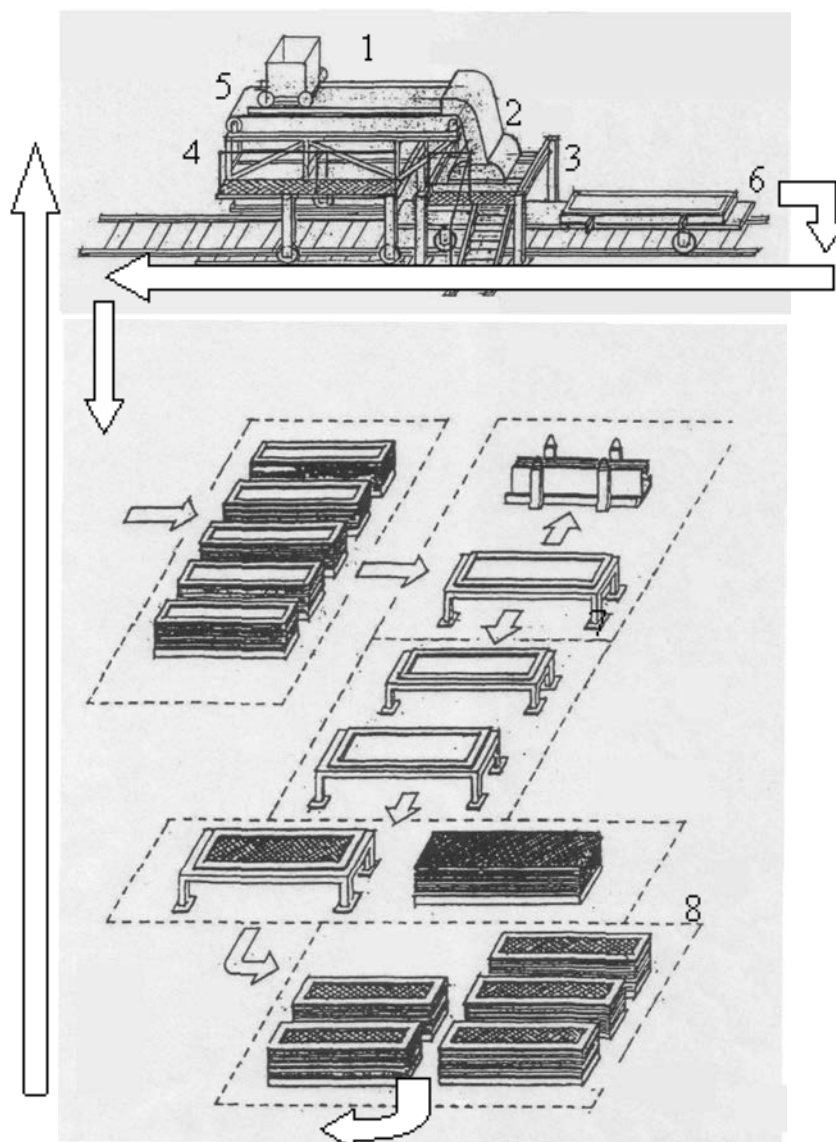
Схема производственного участка бетонирования тонкостенных конструкций в условиях строительной площадки
